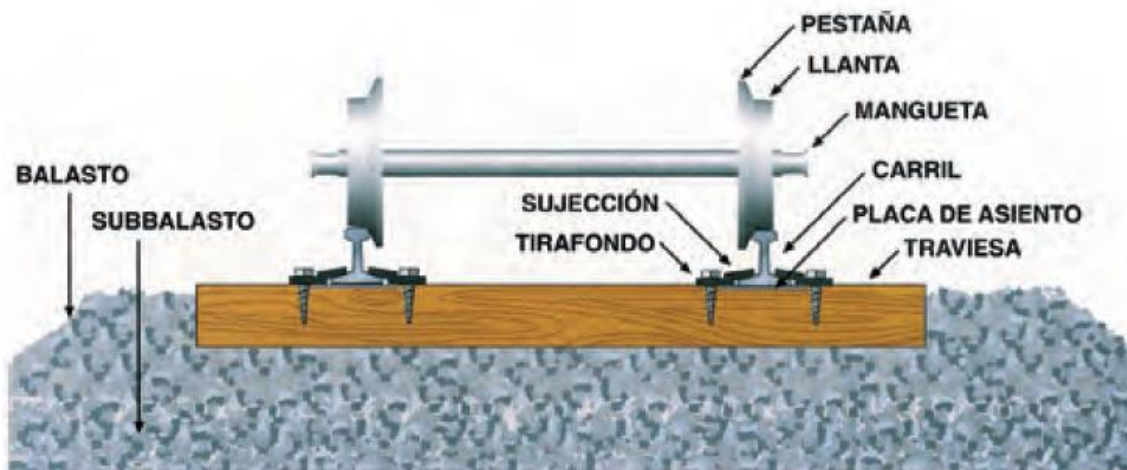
Detalle transversal de los elementos superestructura. (Fuente: López Pita, 2006)
